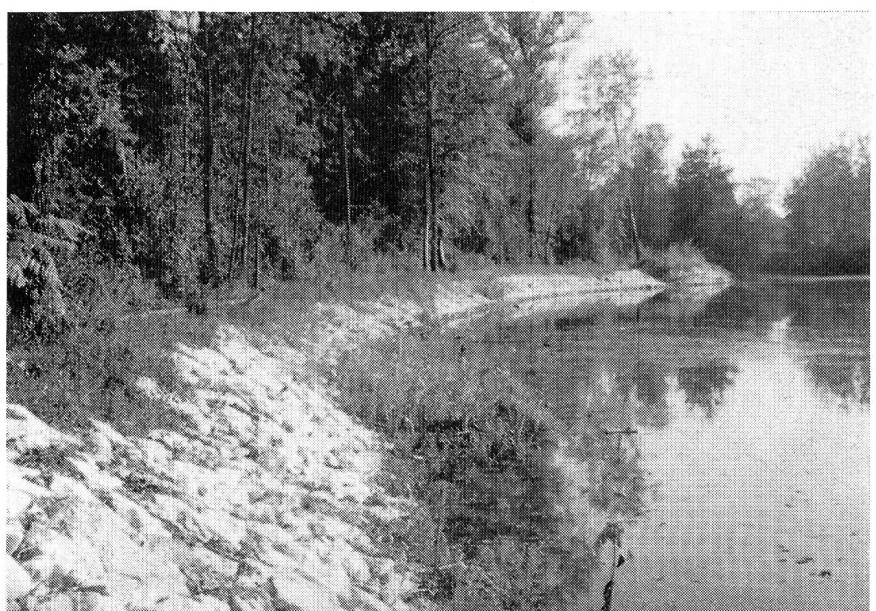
Kiesfang Emmemündung rechtes Ufer. Blick flussabwärts. Die Betonmauer im Hintergrund soll noch mit einer Schilfpflanzung abgedeckt werden
